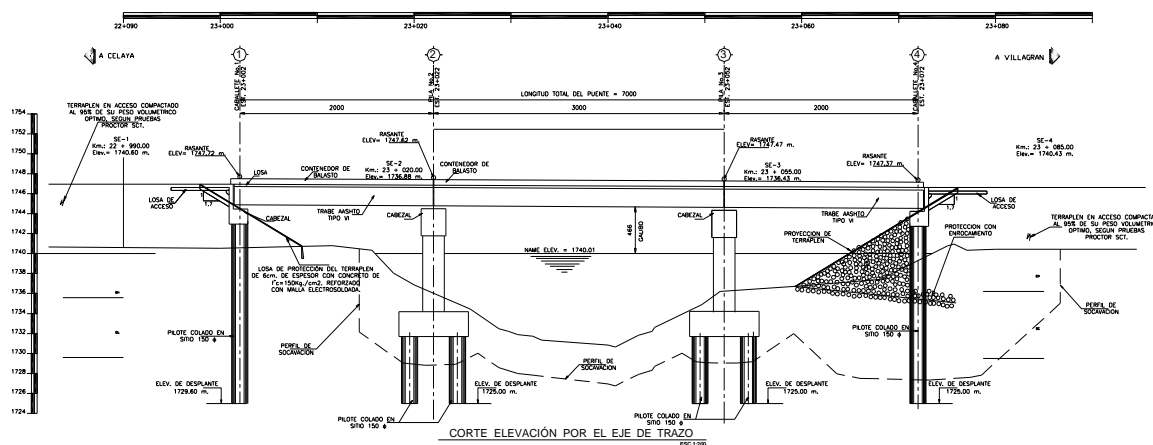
Corte Longitudinal del puente las Lajas III.
